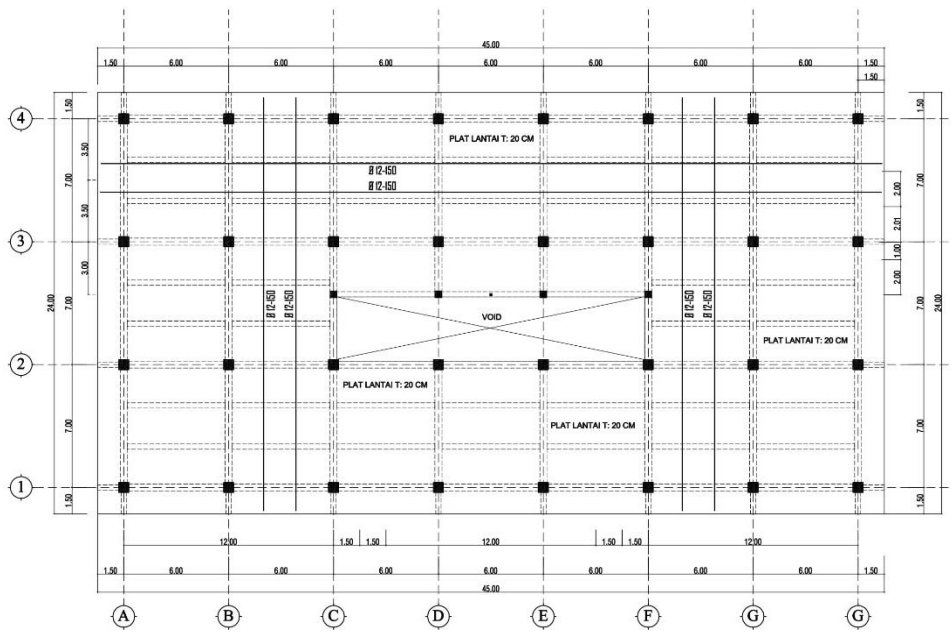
Denah Rencana Plat Lantai basement.
